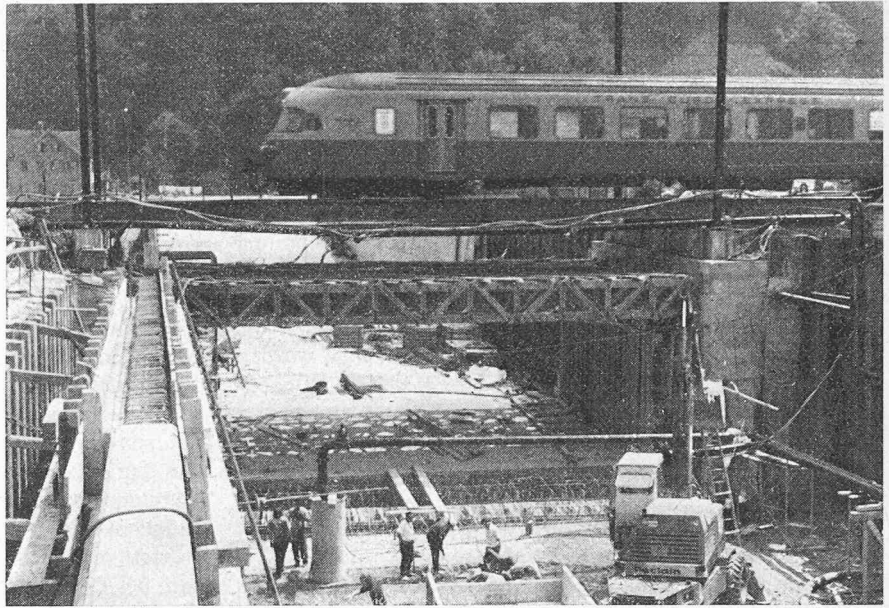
Auflagerwände mit Holzspriessung und den grossen Hilfsbrücken der SBB. Die Bodenplatte der Unterführung ist bereits betoniert. Im Vordergrund ist der Sammelkanal erkennbar
